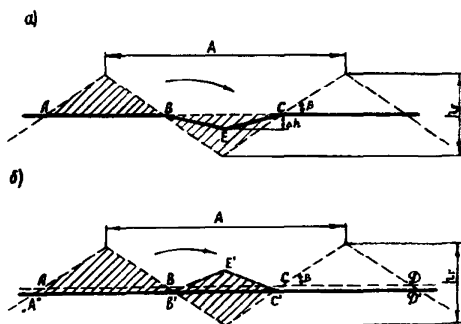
Схема планировки отвалов с большими перепадами высотных отметок: а - без учета усадки; б - с учетом усадки.
